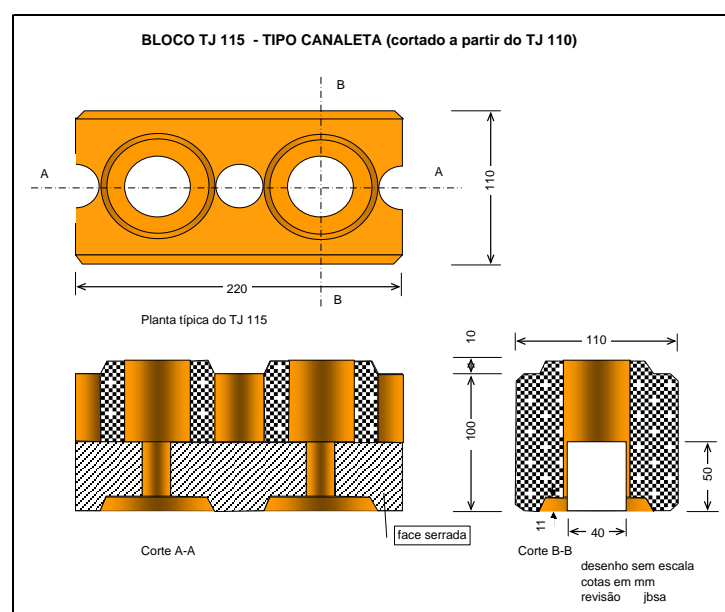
Planta e cortes do bloco TJ 115, usado para vigas e cintas
